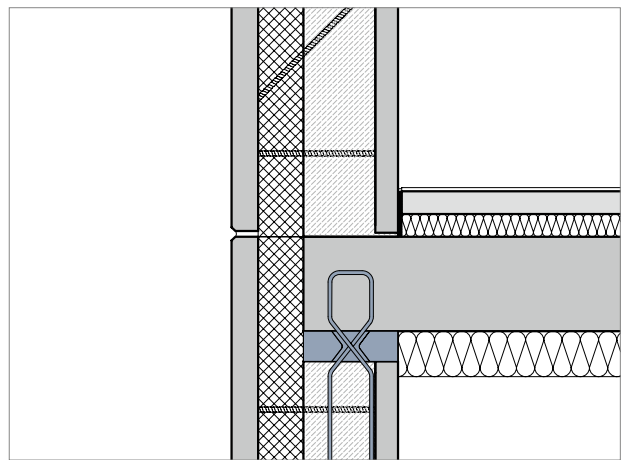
Schematische Darstellung Schöck Sconnex® Typ W bei Elementwänden und Unterdeckendämmung
